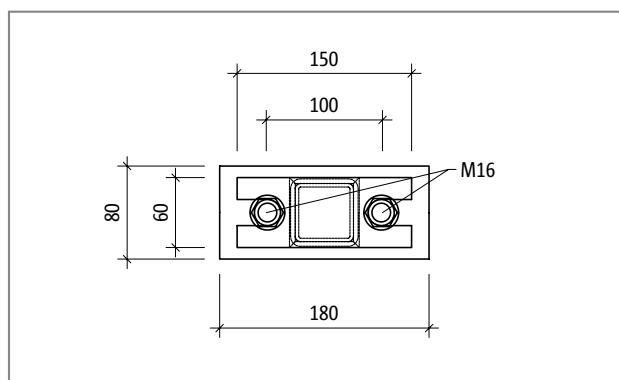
Schöck Isokorb® T tipo S-V-D16: vista dell'elemento
